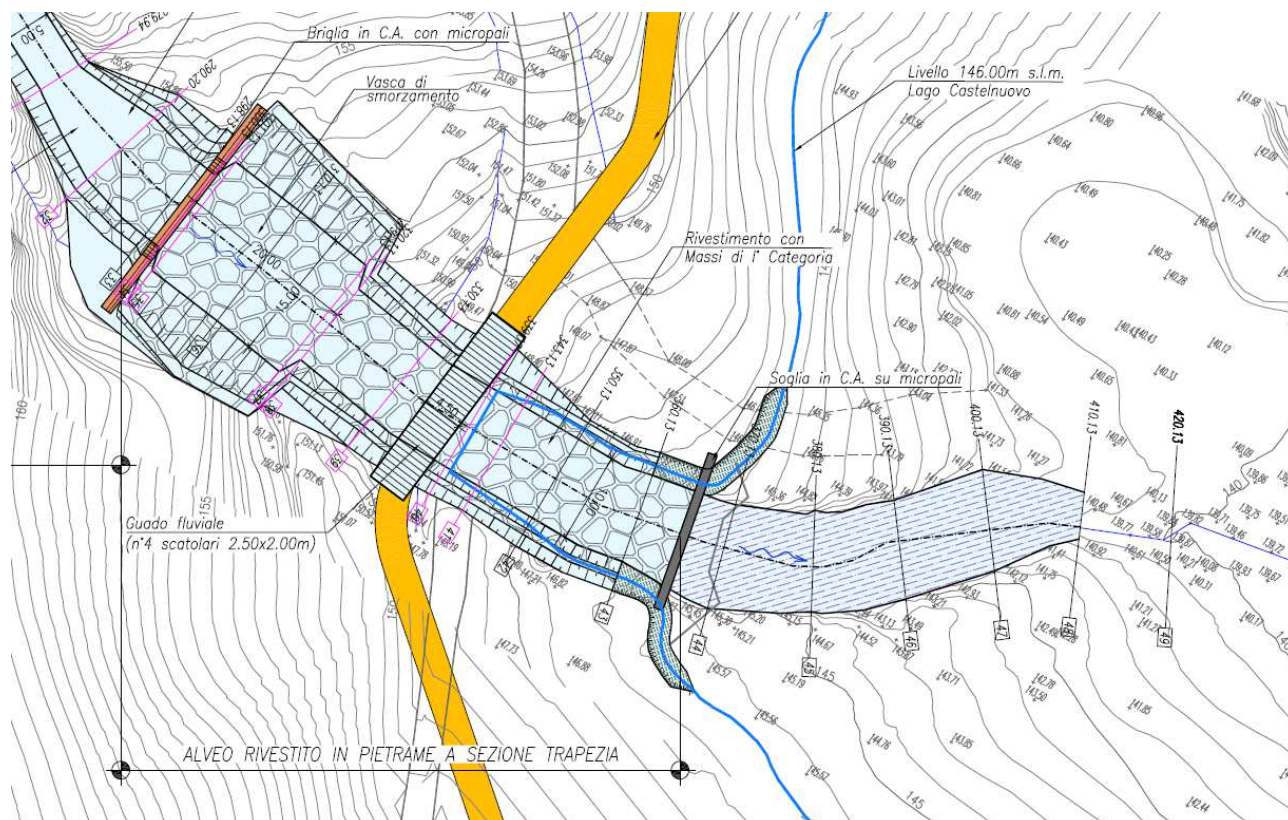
Planimetria Tavola 3/3 – Borro Pianale
